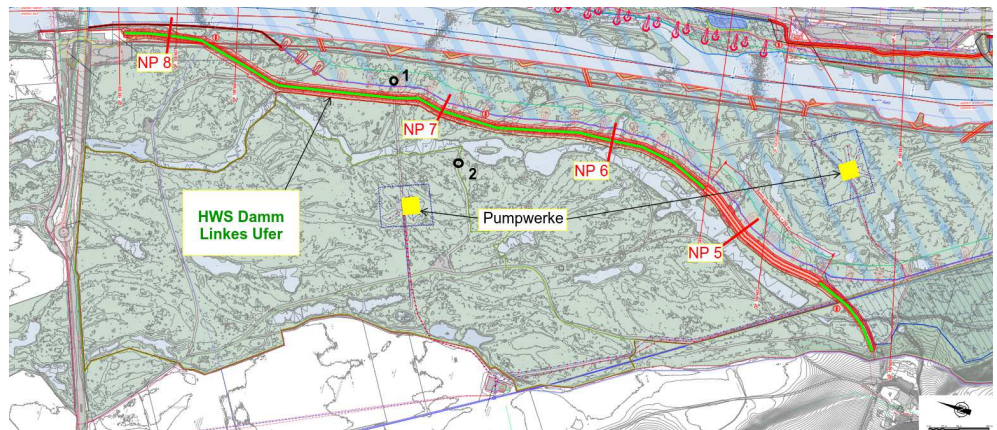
Lageplan, Hochwasserschutzdamm linksufrig
